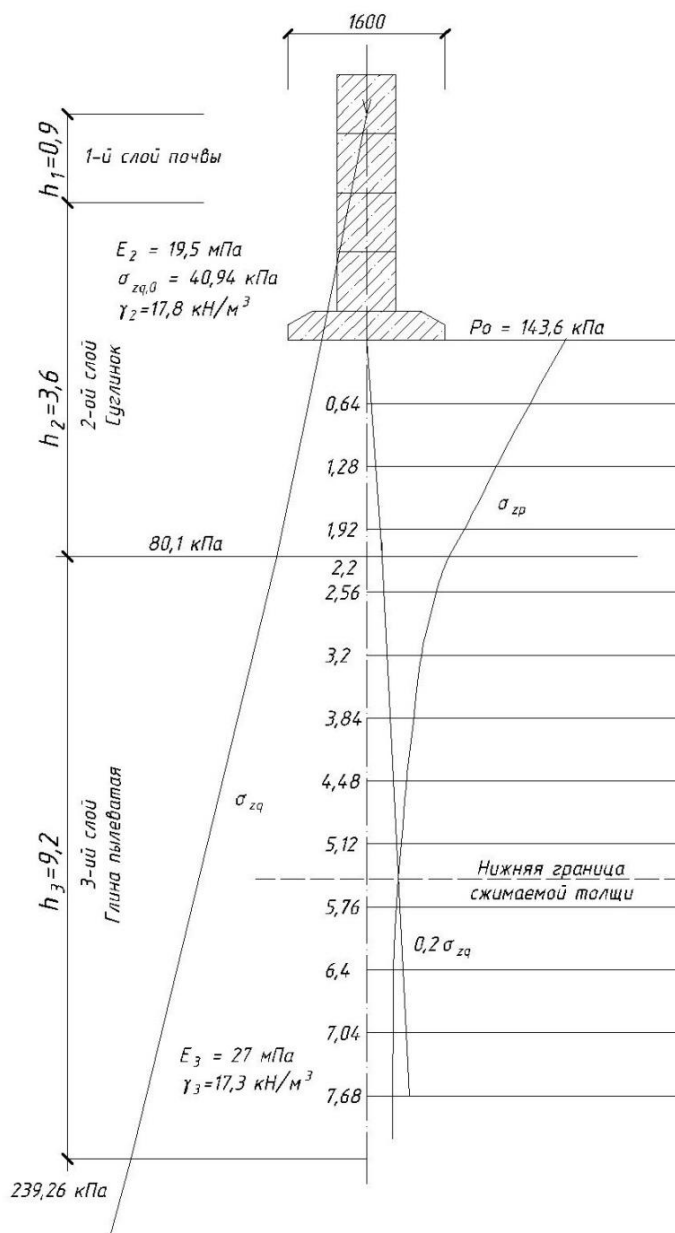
Расчетная схема осадки ленточного фундамента первого типа
